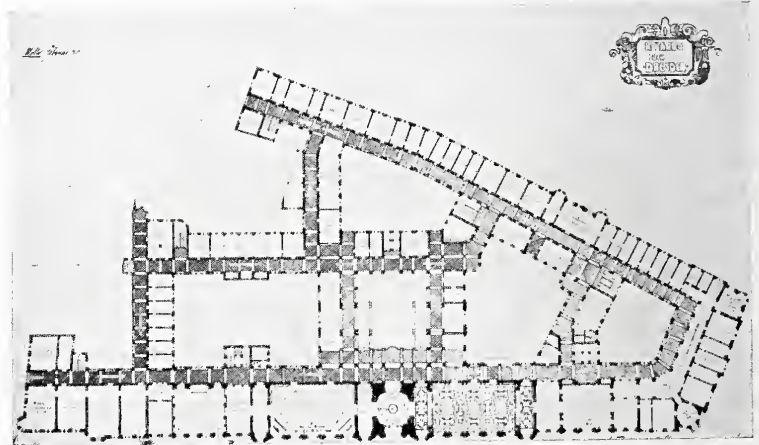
Grundriß vom II. Obergeschoß (Hauptgeschoß).
